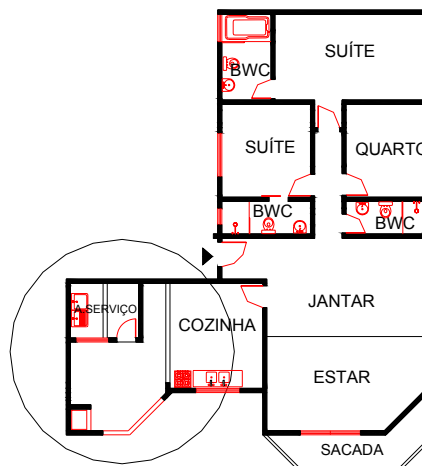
Planta Baixa dos apartamentos 303 e 603 – Estudo de caso B.
